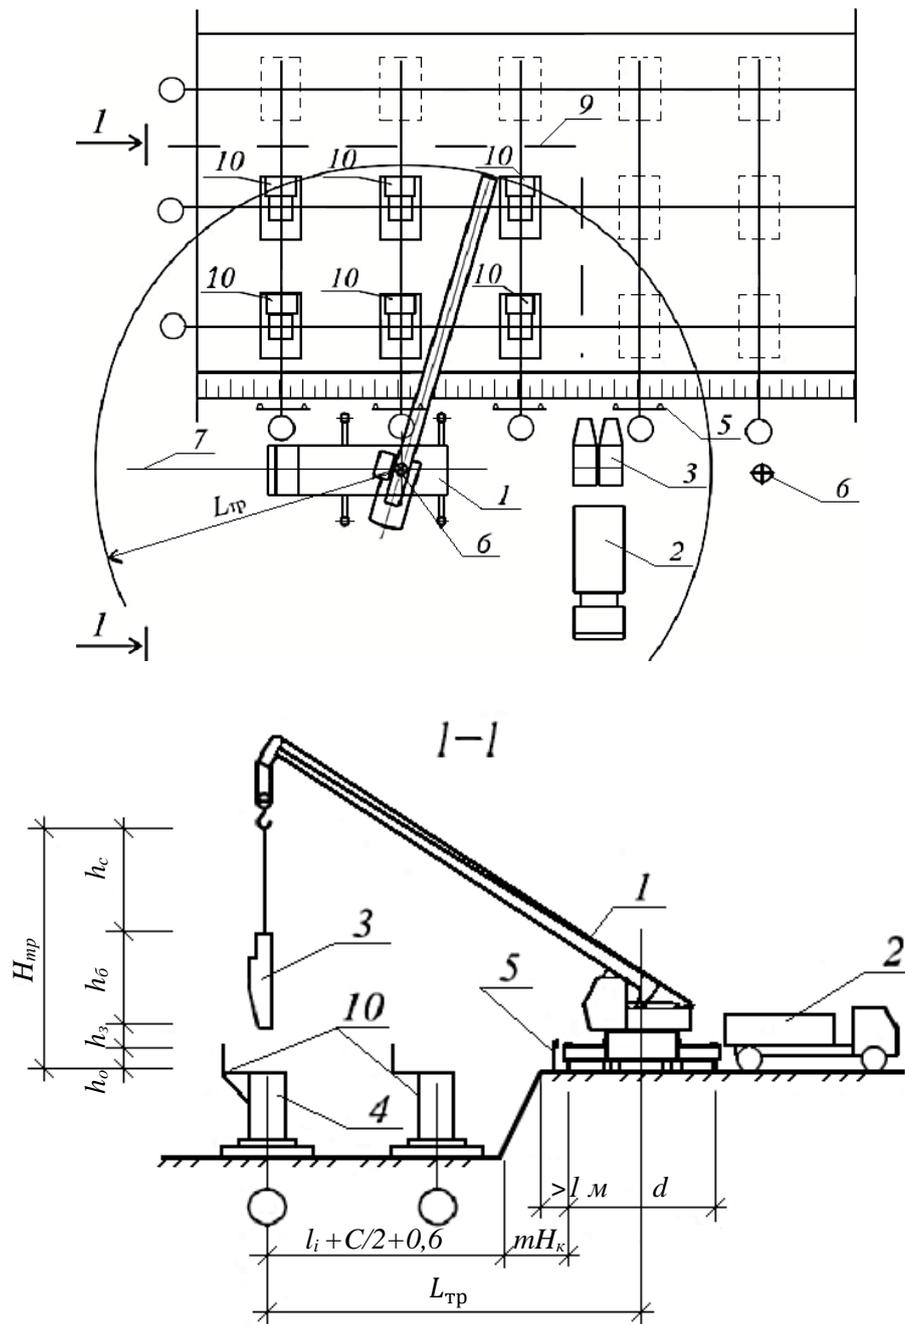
Схема бетонирования фундаментов с бермы котлована или траншеи:
